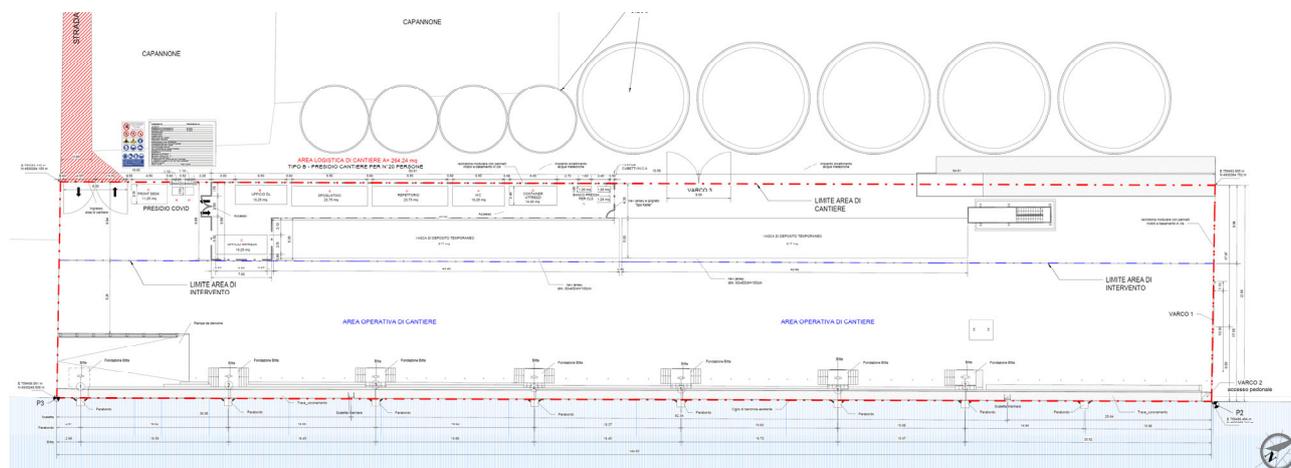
Banchina Bunge Sud – Layout generale di cantiere
